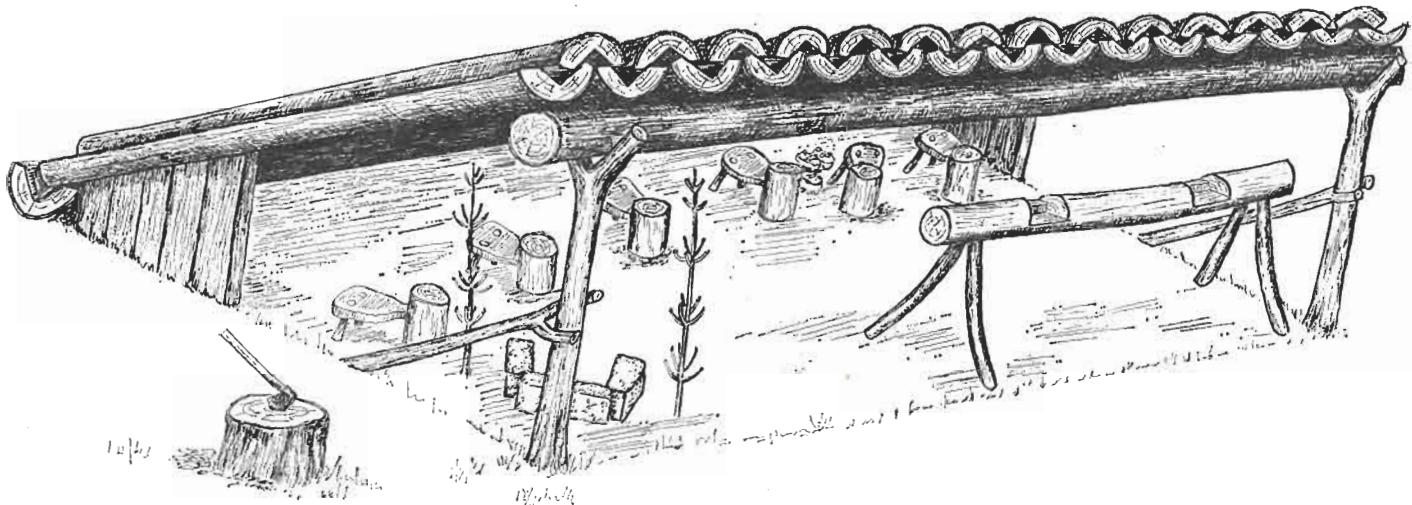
Fig. XIII.—Proyección isométrica de la cabaña, cuya planta y alzado están en la figura siguiente.
